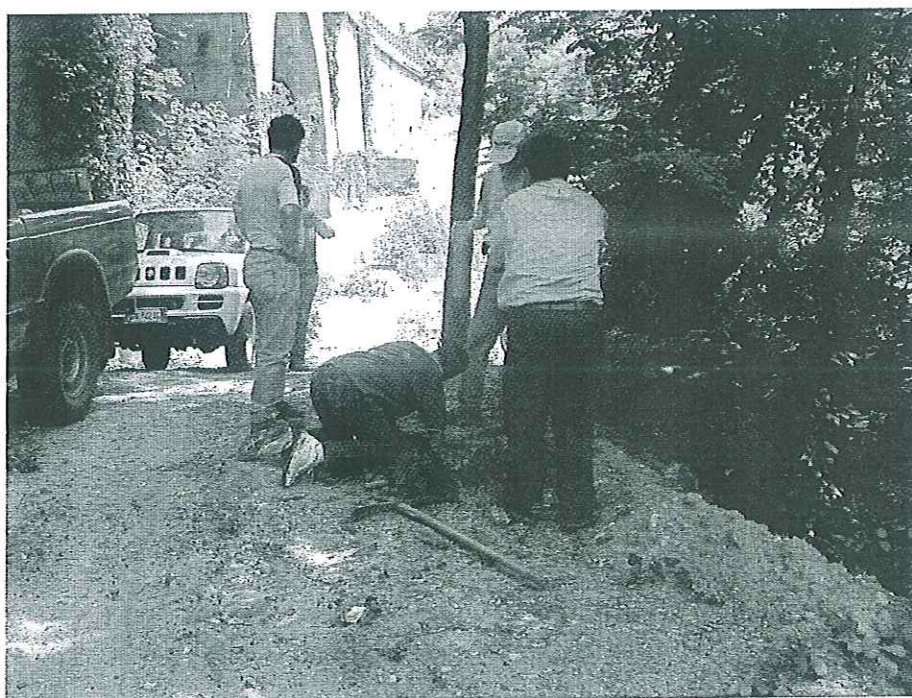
GN04-05 Galleria Fontanelle imbocchi lato Reggio Calabria - Sito RAD008 - Posa in opera campionatore
